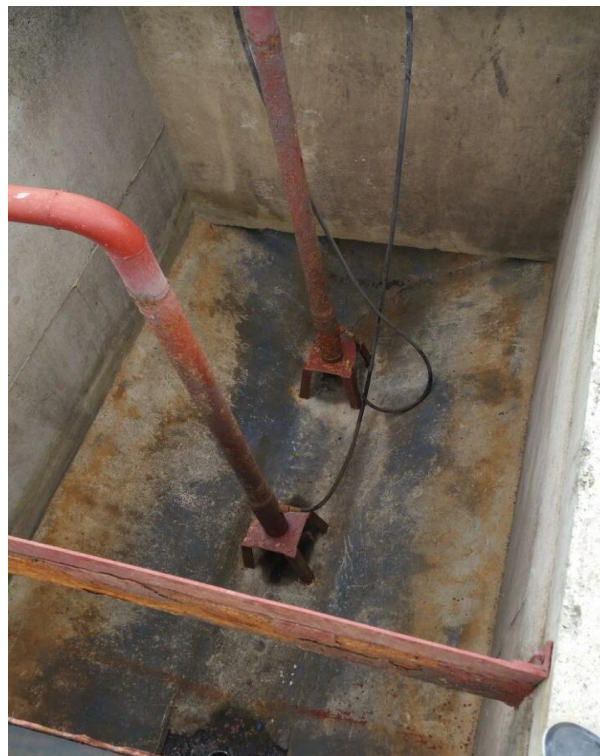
Detalle Sedimentador bombas de recirculación. Fuente: Los autores
